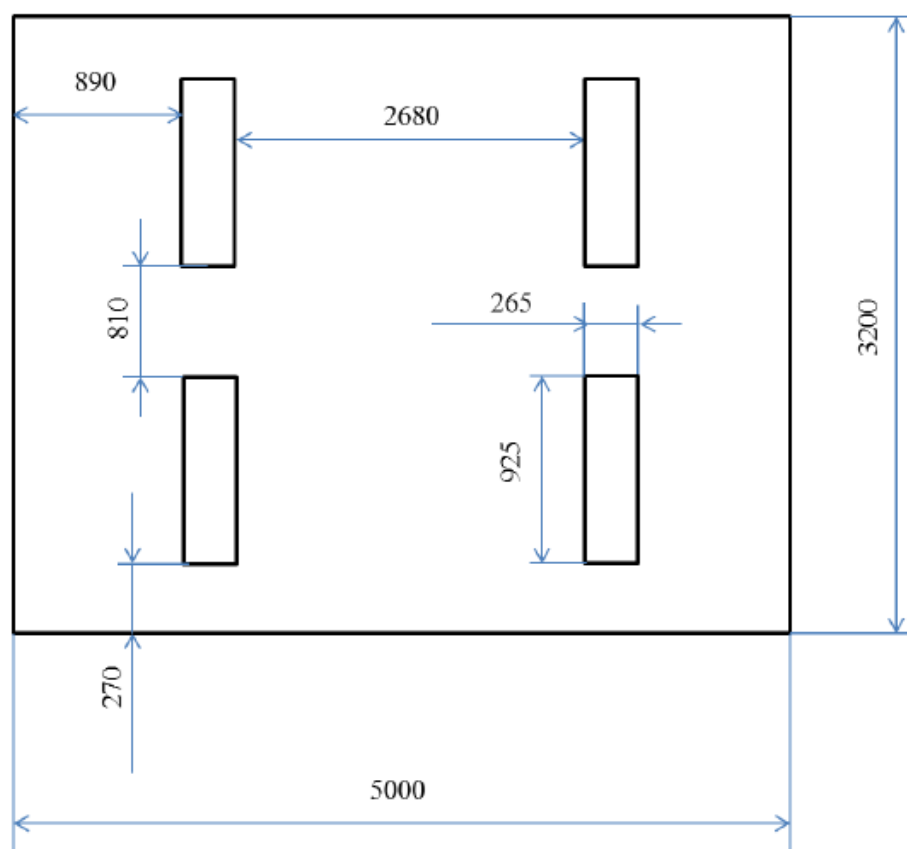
План помещения и размещения светильников с люминесцентными лампами.
